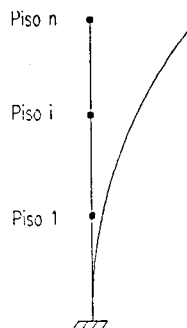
Configuração de instabilidade - REBAP [1].
